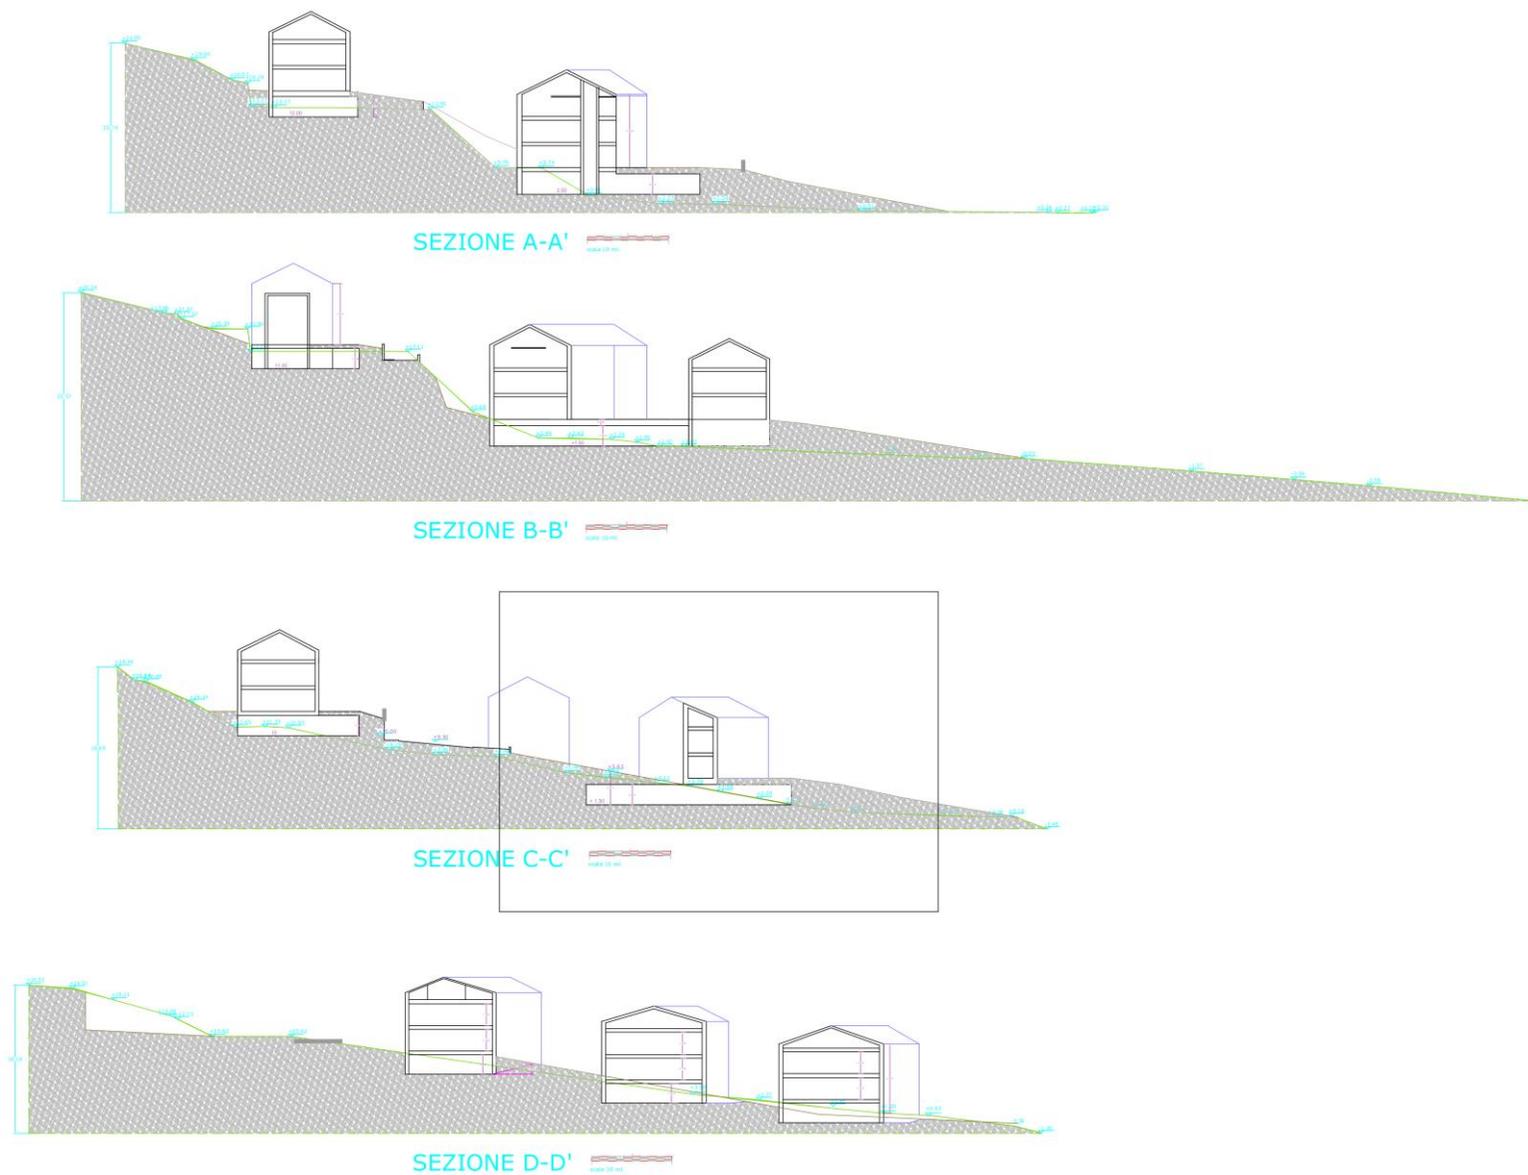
Tavola 1: Elaborato di progetto – sezioni
